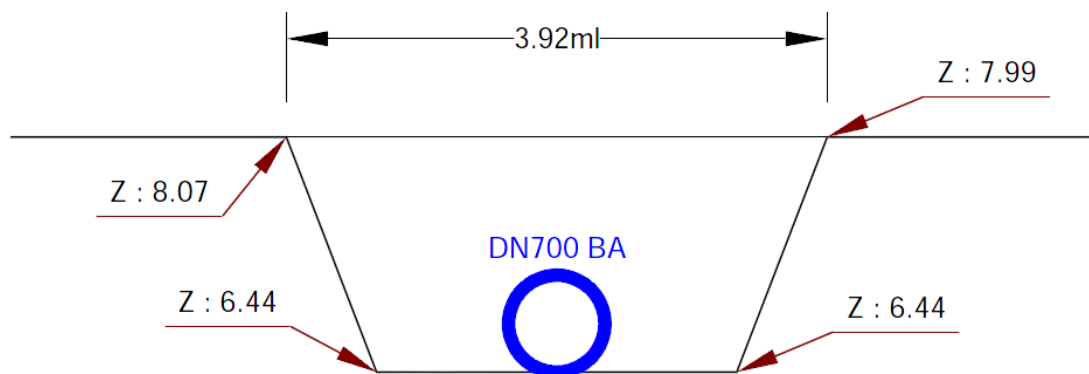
Profil en travers du ruisseau temporaire au droit du tracé de la canalisation de rejet projeté (Source : INGEAU)
